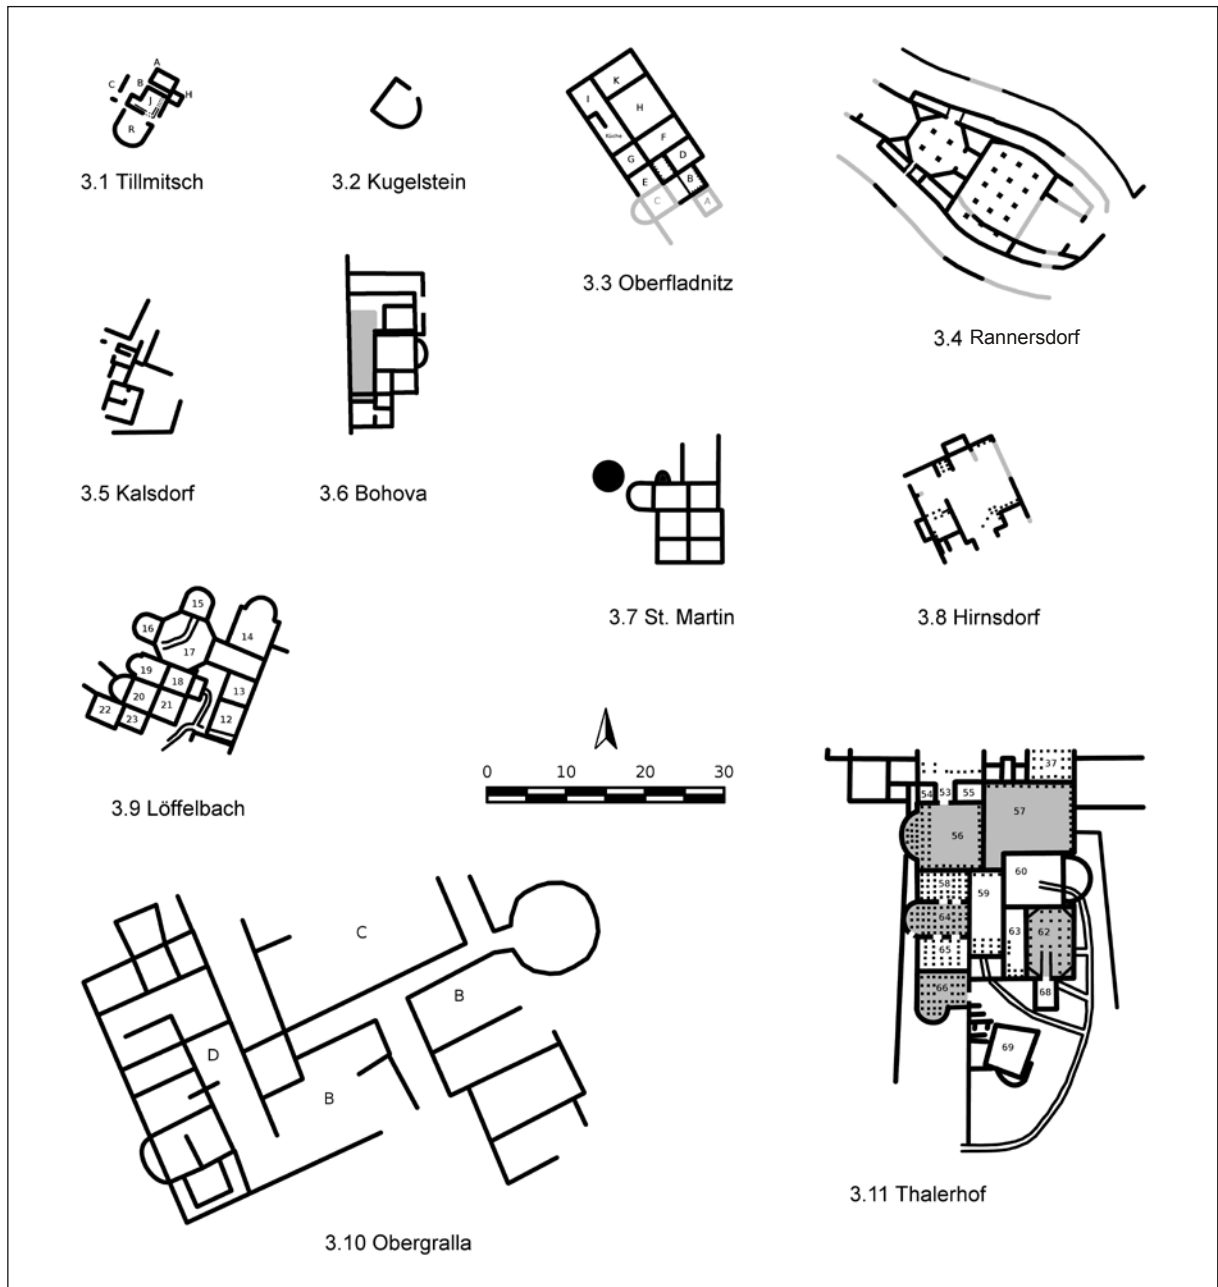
Grundrisse der Badeanlagen (P. Marko)
